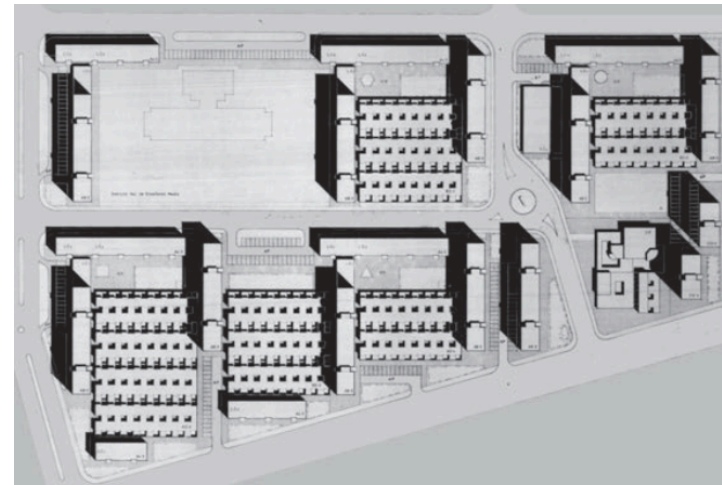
Plano del conjunto. *Hogar y Arquitectura. No 106 (1973)
